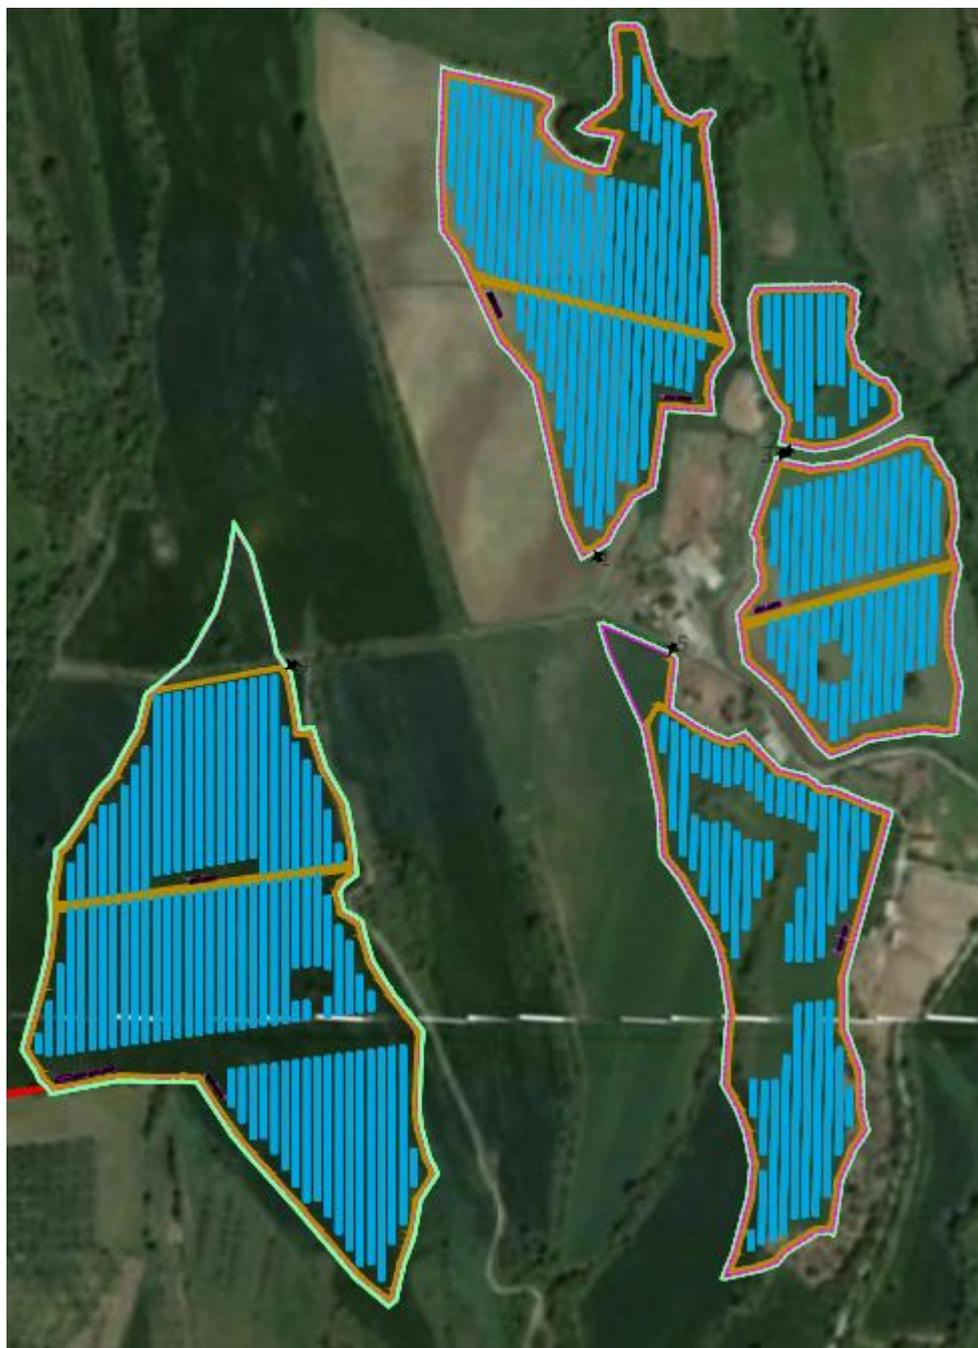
Layout preliminare – Impianto denominato EG ORTENSIA
